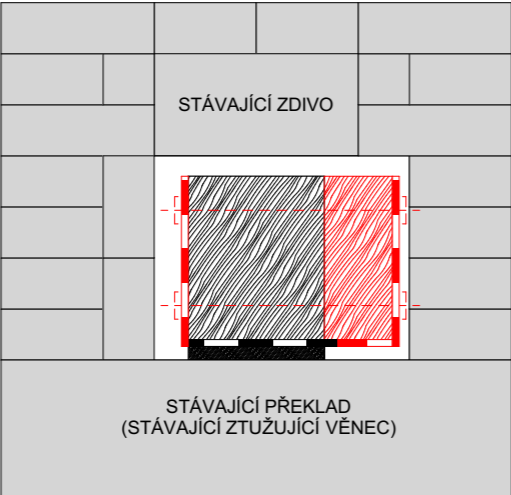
DETAIL ULOŽENÍ STROPNÍHO TRÁMU
